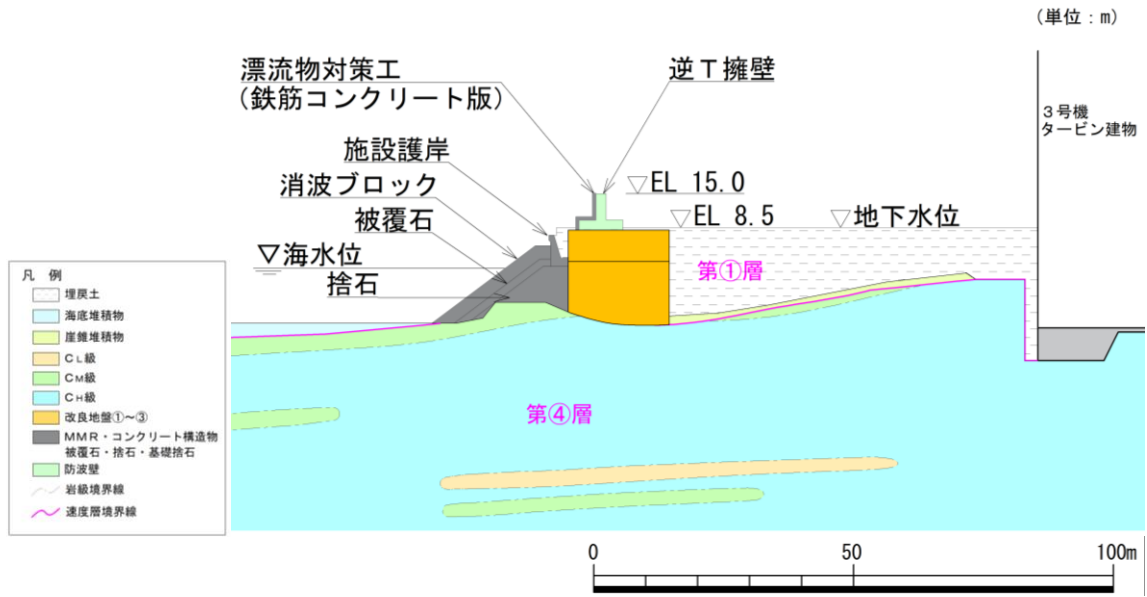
防波壁（逆T擁壁）の横断面図（⑤-⑤断面）
